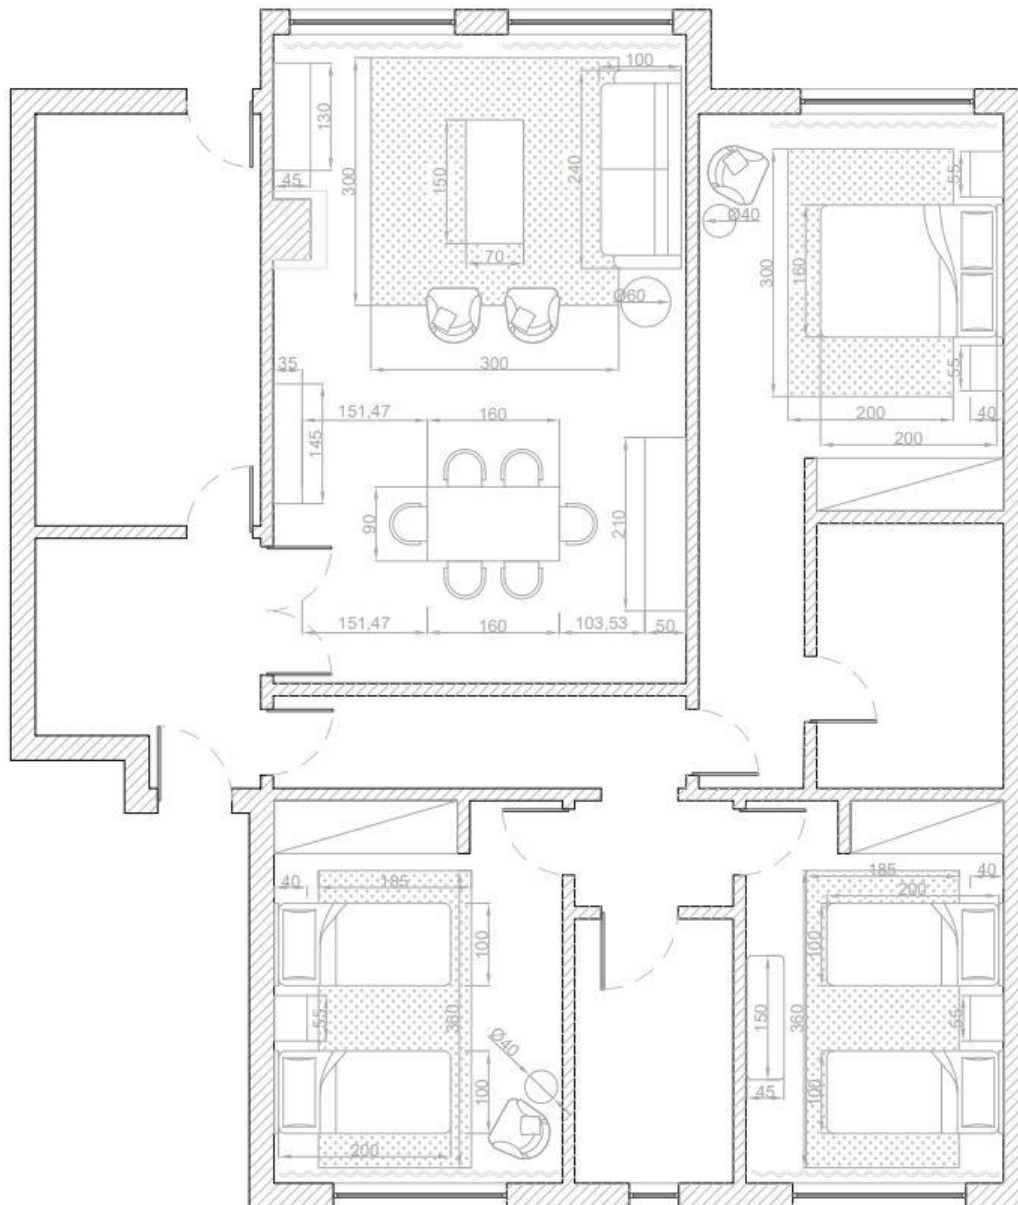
Planta de Equipamento Cotada Praia del’Rey
